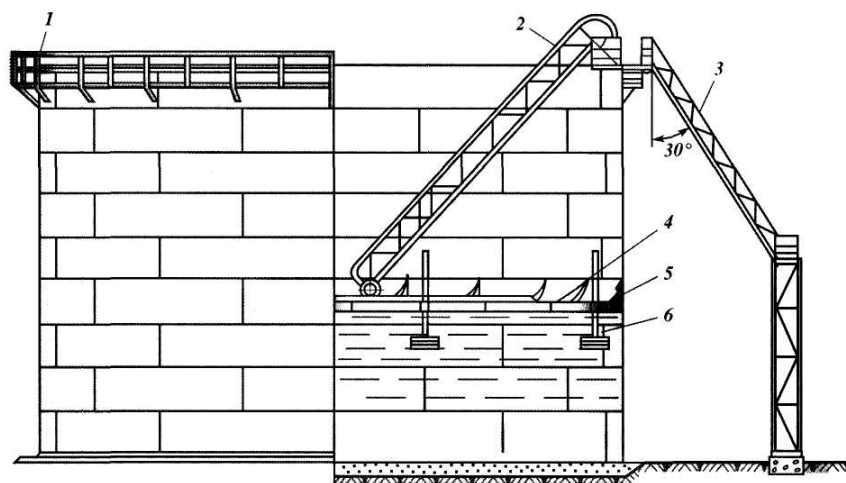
Резервуар з дводечним плаваючим дахом: 1 – перила; 2, 3 – рухомі й нерухомі сходи; 4 – плаваючий дах; 5 – затвор; 6 – опорний стояк
